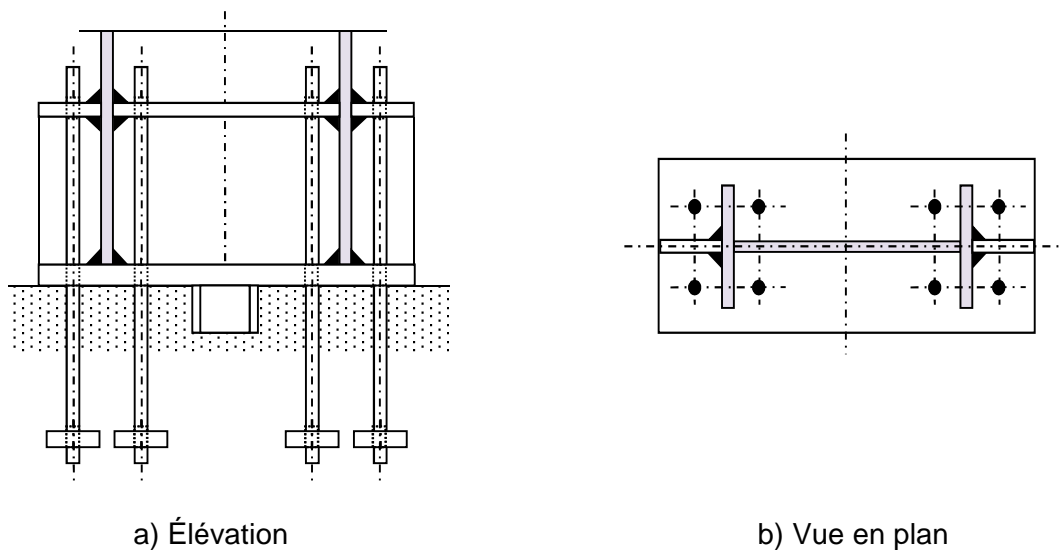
Exemple d'encastrement avec châssis d'extrémité.
